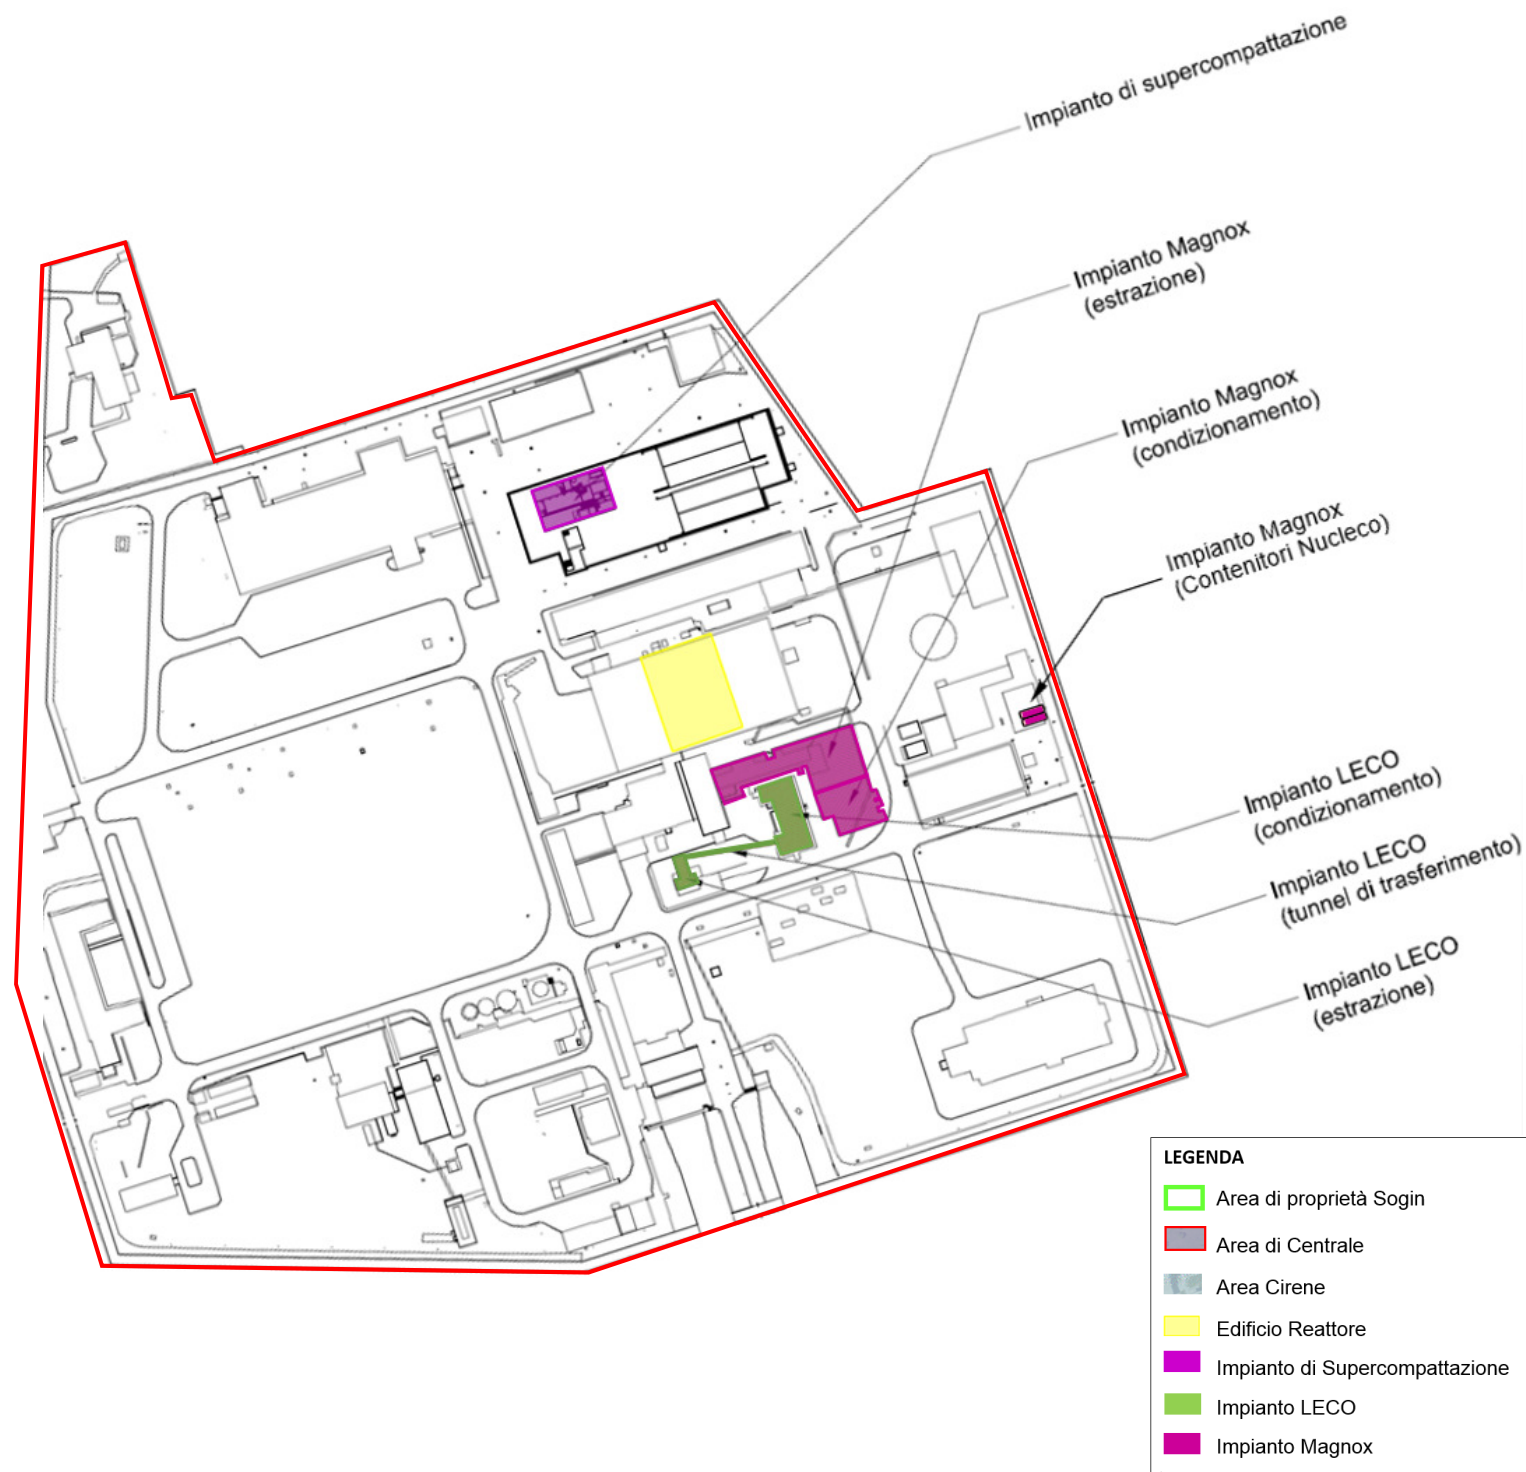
Planimetria generale - Localizzazione dell'Area di intervento e degli impianti all'interno dell'area di Centrale
